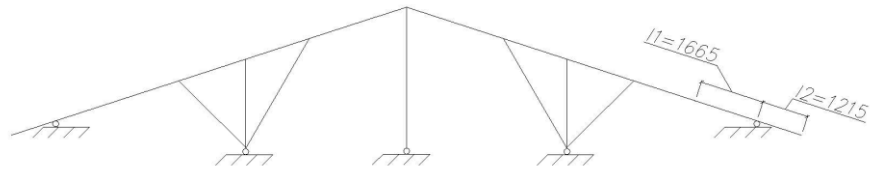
Расчетная схема нагрузки на простенок от конструкции кровли.
